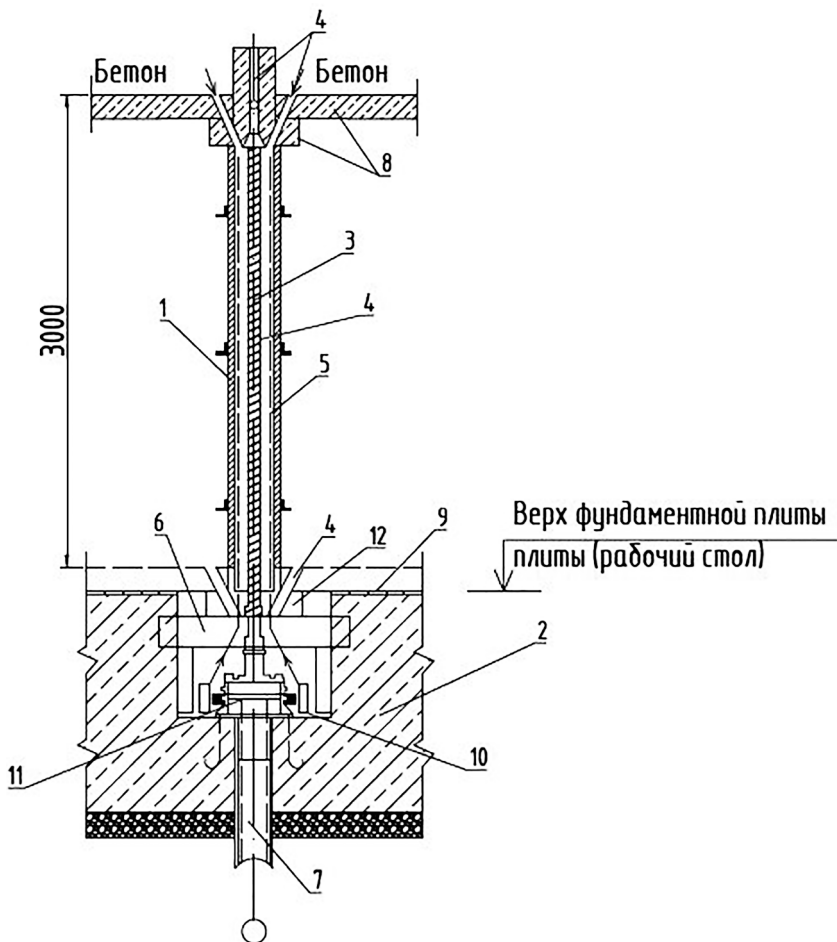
Схема подготовки конструкции очередного этажа (колонн, капителей и плиты перекрытия) к бетонированию и последующему подъему с помощью винтовых домкратов: 1 – сборно-разборная опалубка колонны; 2 – монолитная железобетонная фундаментная плита с каналами; 3 – шток винтового домкрата; 4 – пластмассовый шаблон для размещения штока внутри колонны, бетонирования колонны и капители; 5 – напрягаемая арматура колонны; 6 – опорные балки; 7 – обсадная труба (пластиковая) в скважине; 8 – ранее забетонированные и поднятые конструкции вышележащего этажа; 9 – рабочий стол, на котором бетонятся конструкции очередного этажа; 10 – электротяга; 11 – винтовой домкрат; 12 – плита перекрытия
